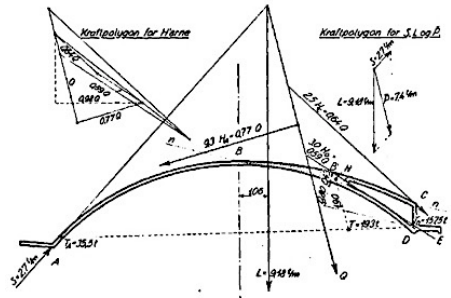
Esquema de semejanza entre viga de hormigón armado y cáscara cilíndrica larga. H. Lundgren H. Cylindrical Shells, Vol. I, The Danish Technical Press the Institution of Danish Civil Engineers, pp: 55, 1949
